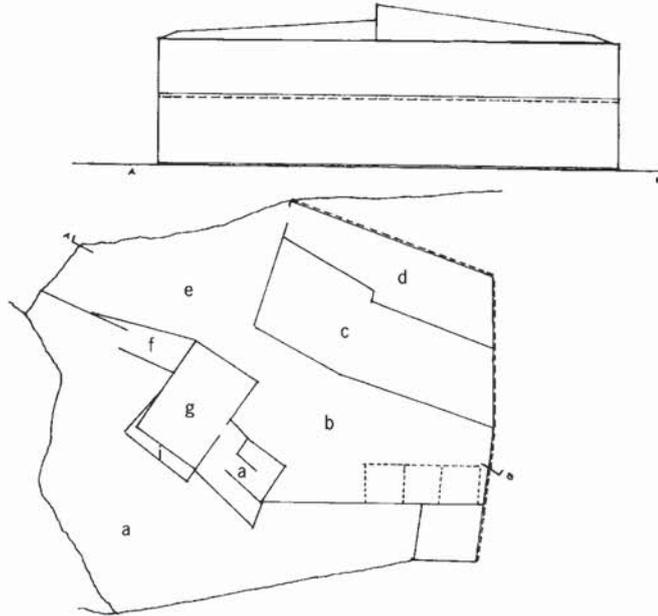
Planta das instalações da Fábrica do Senhor d'Além, em 1861/70
